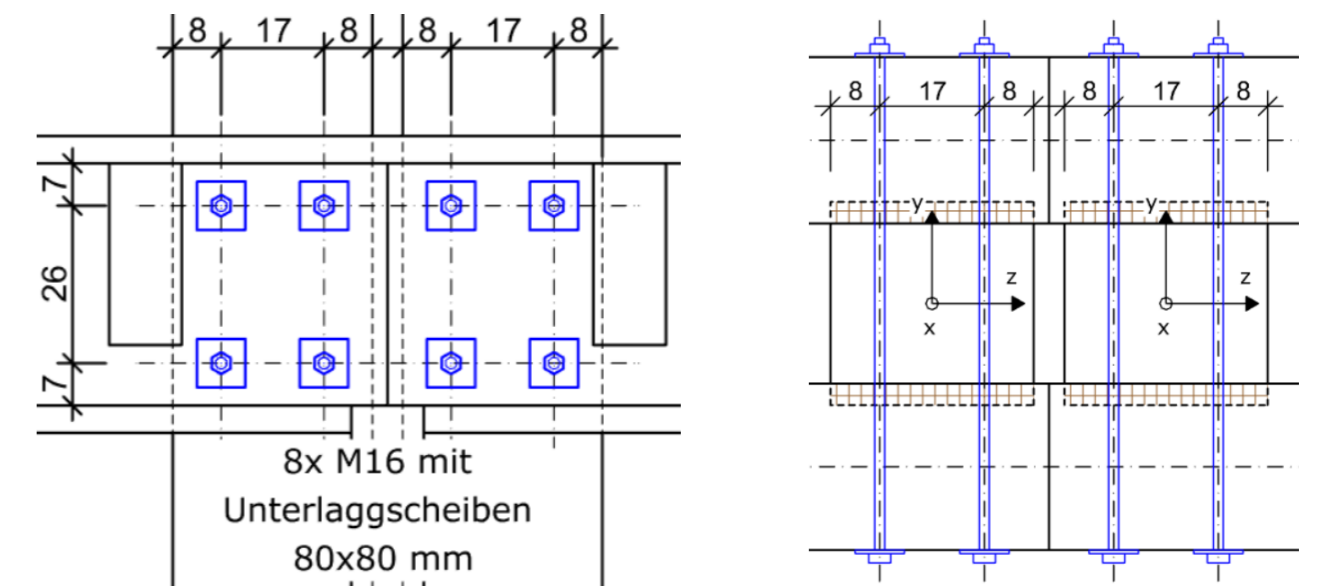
Ansicht & Grundriss Knoten [cm]
